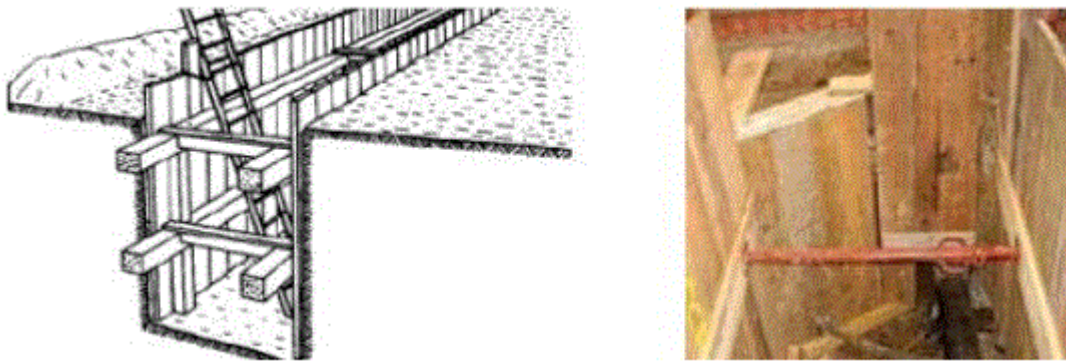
BLINDAGE PAR PANNEAUX PREFABRIQUES EN BOIS (5)
